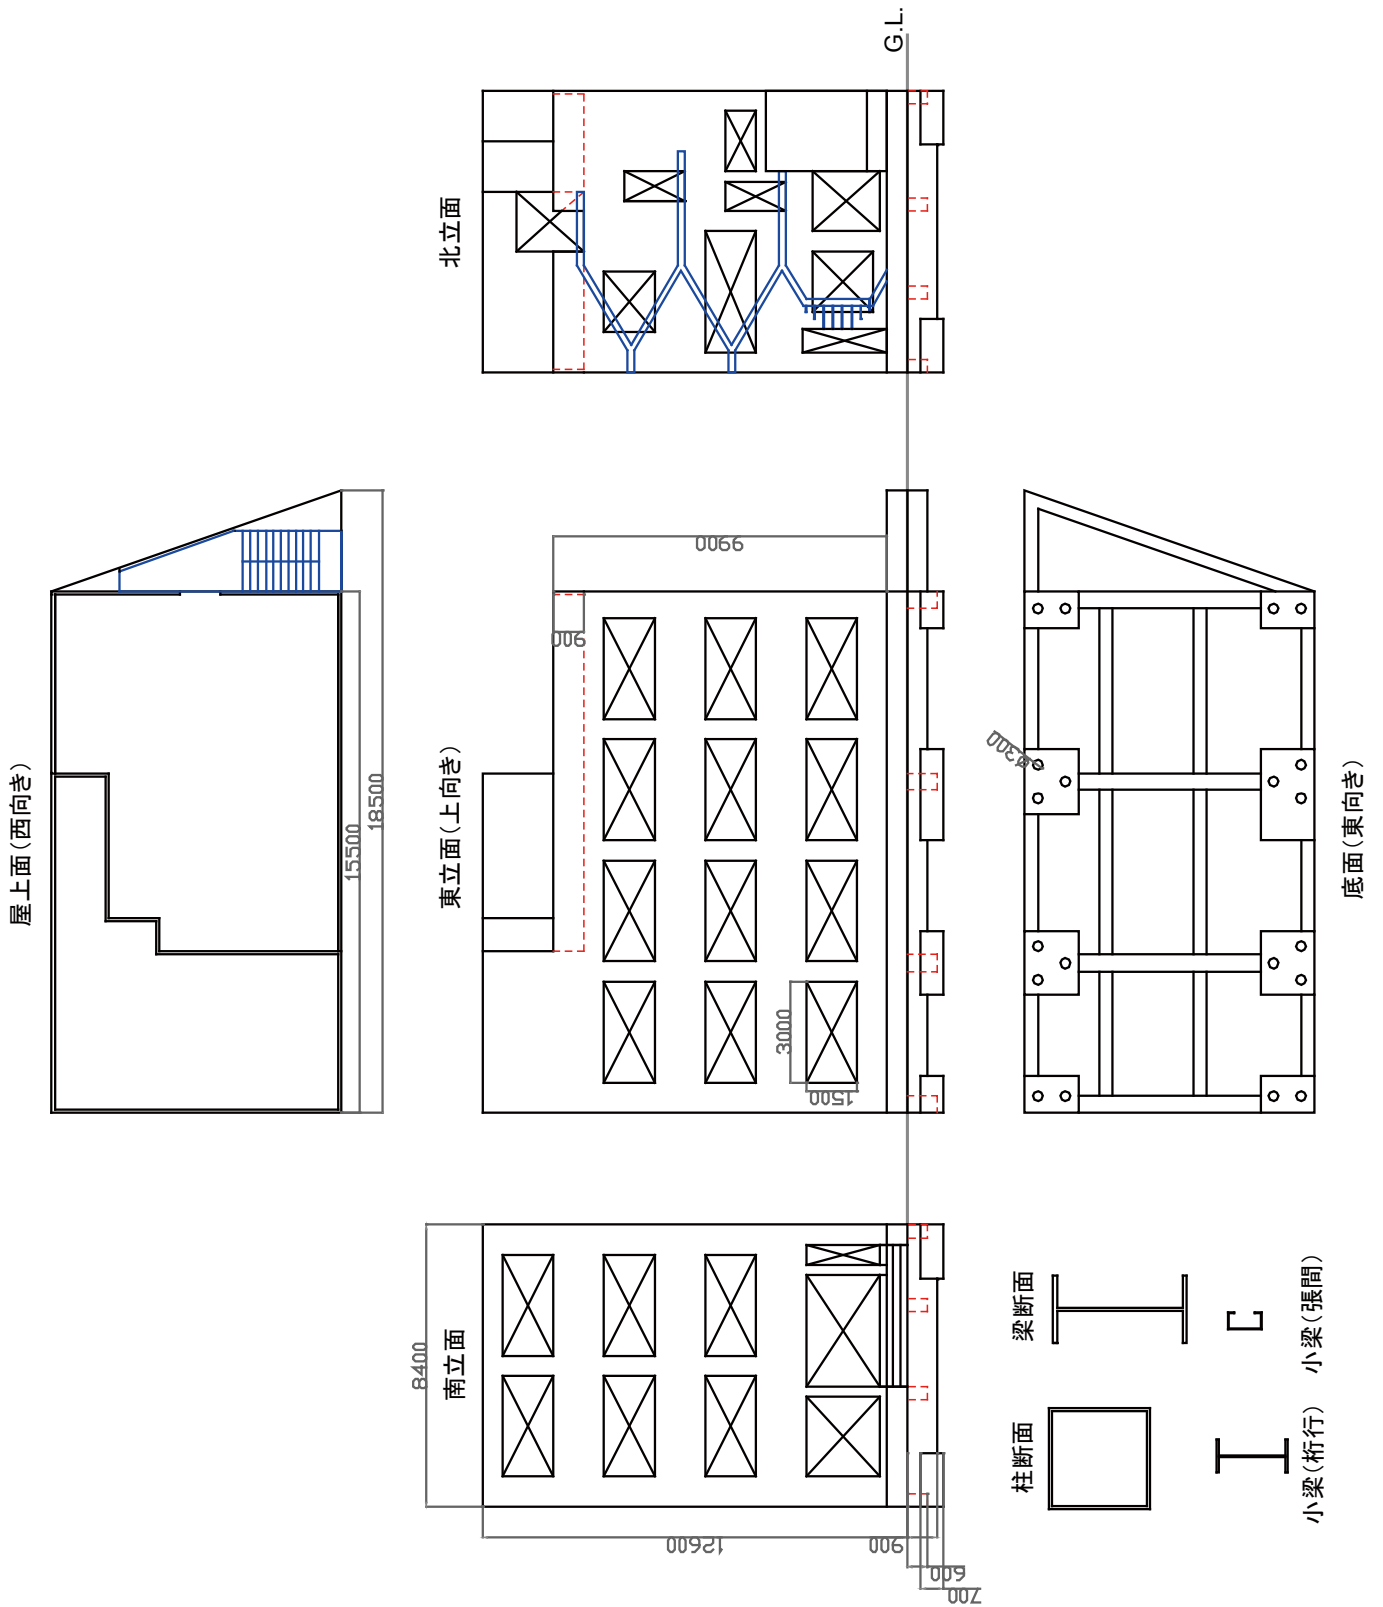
調査対象建物 立面図・見付図 (単位: mm)
